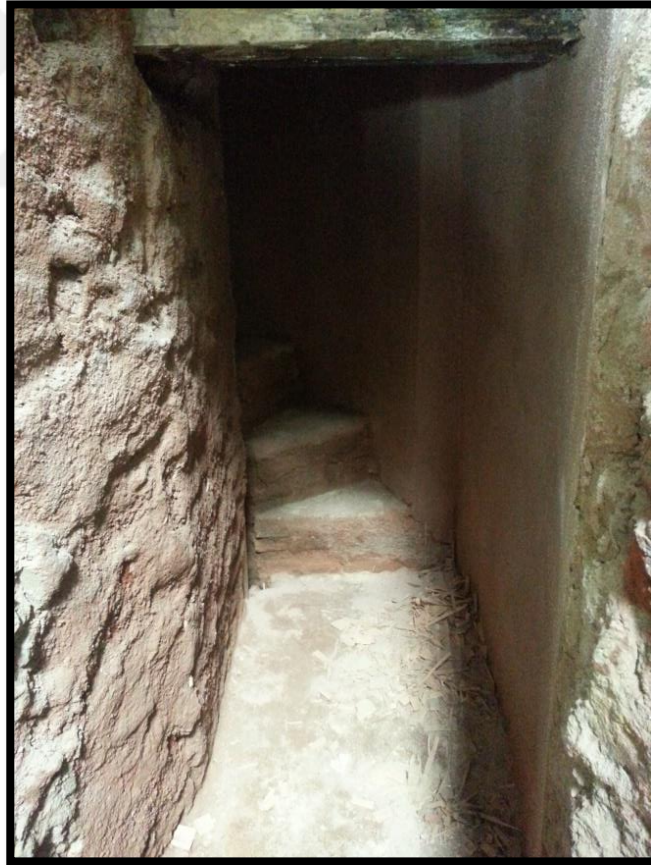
Güney cephede mihrap nişinde bulunan betonarme eklenti.
